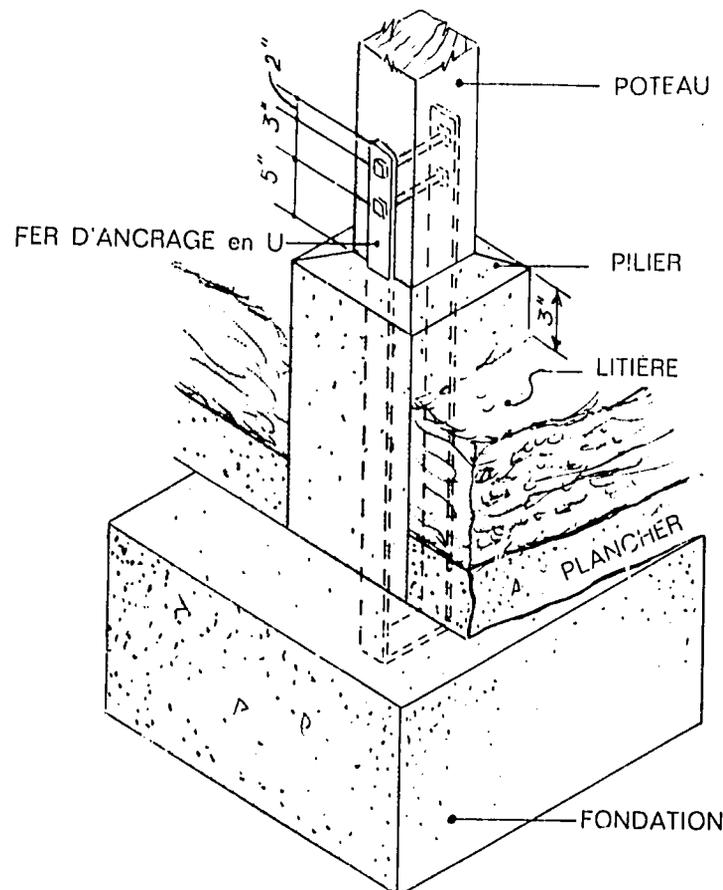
Détail du pilier en béton et du fer d'armature des poteaux en bois. Remarquer que la bride de fer en U est ancrée dans la fondation.
